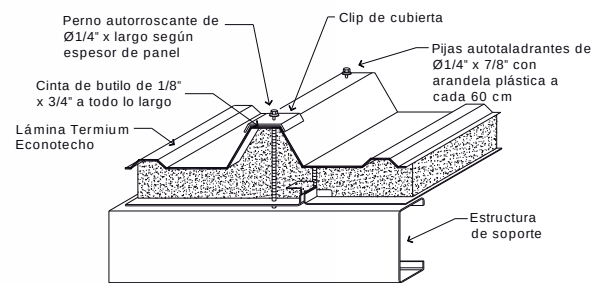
Unión de cubierta tipo sándwich con estructura metálica. Elaboración propia.
